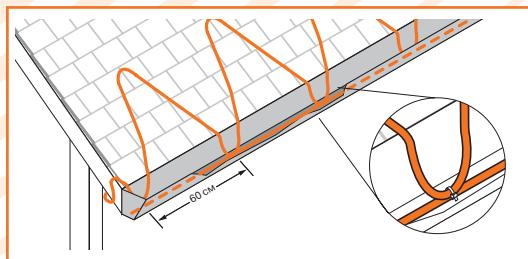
Укладка саморегулирующегося кабеля THERMON, EBECO на "мягкой" кровле
